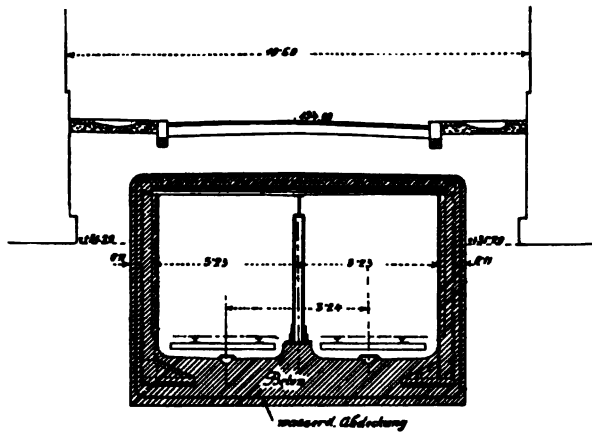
Querschnitt der Berliner Untergrundbahn unter der Niederwallstraße.
